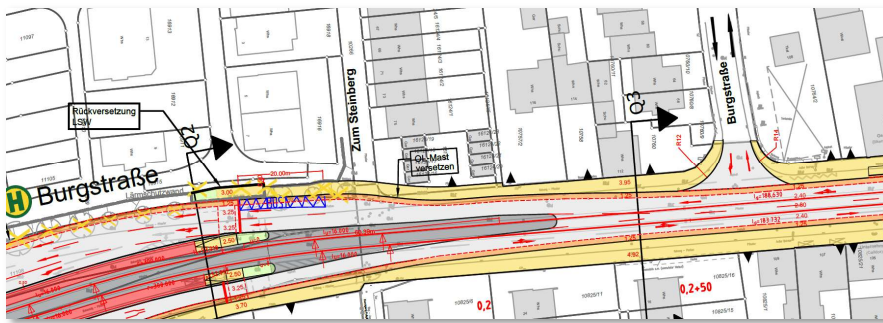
Lageplanausschnitt ohne Linksabbieger Burgstraße
